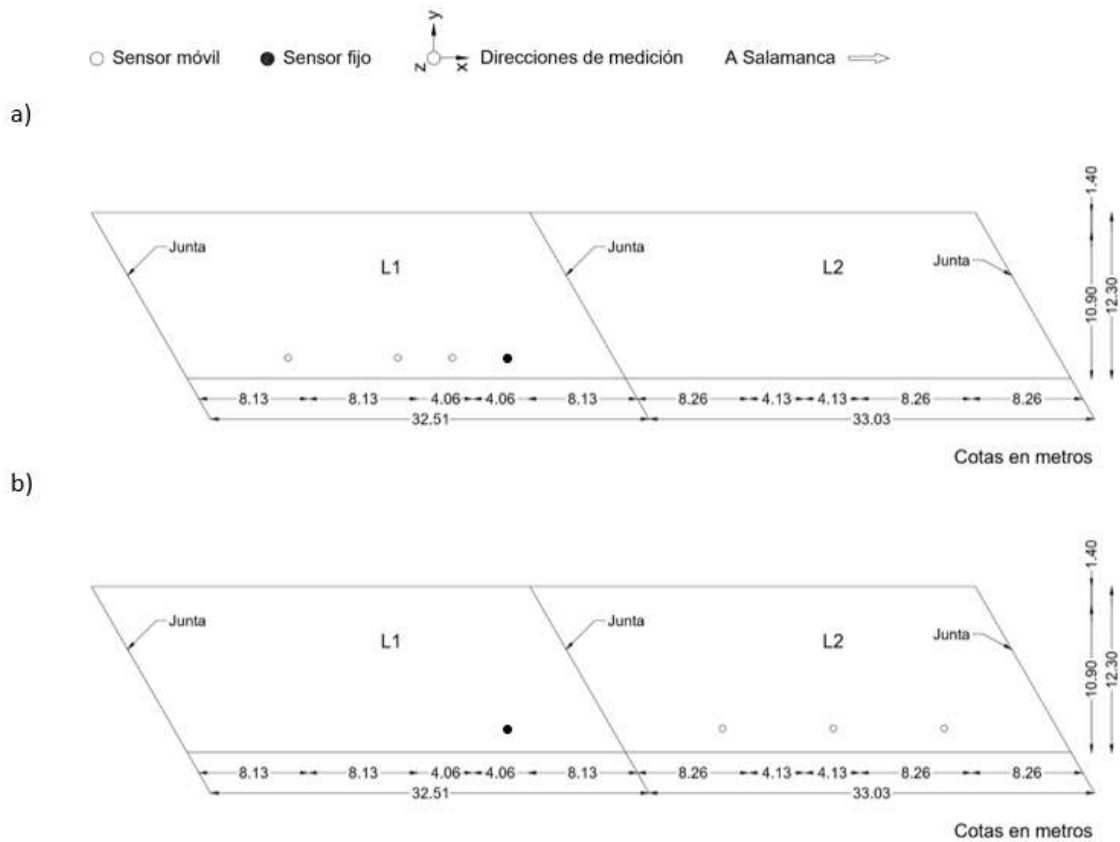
Distribución de los sensores puente El Lago: a) primera configuración de sensores, b) segunda configuración de sensores
